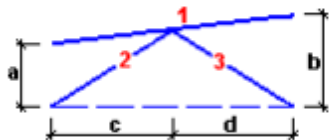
Конструктивне рішення опорного вузла, загальний вид
